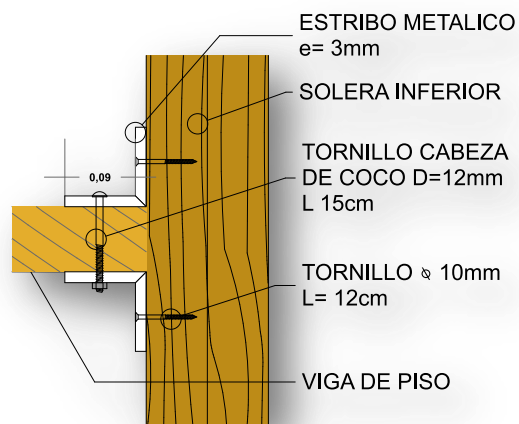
ANCLAJE DE VIGAS Y SOLERAS
